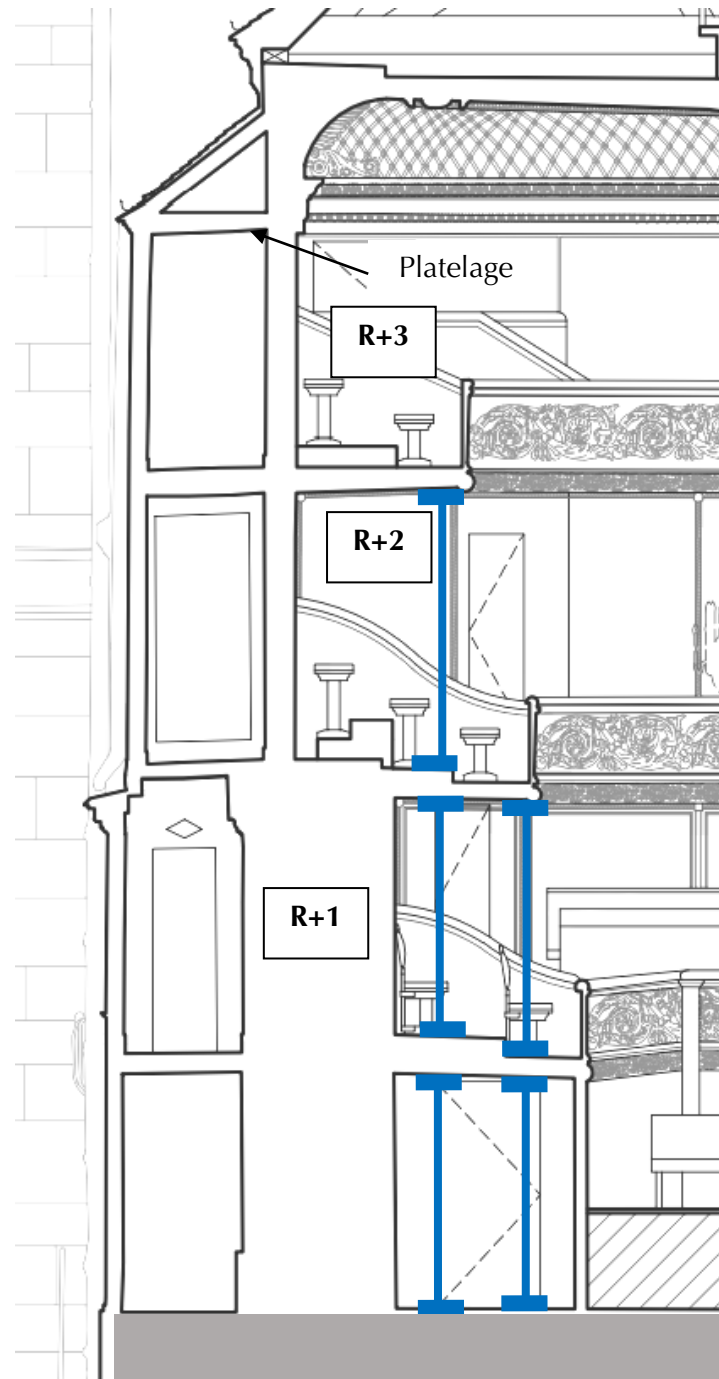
Détail des étaieements à mettre en œuvre sous l'ensemble des balcons - Fond de plan coupe transversale architecte
